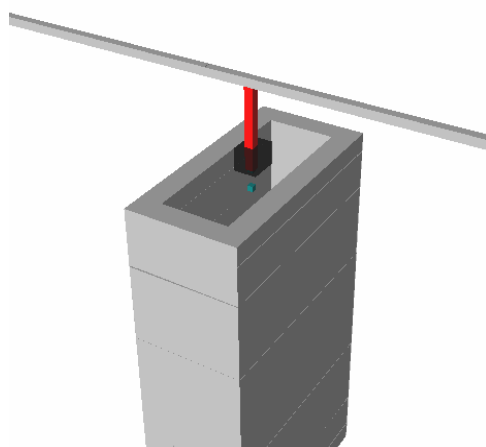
Modelação da ligação tabuleiro – pilar com elemento rígido rotulado na extremidade sobre o pilar
